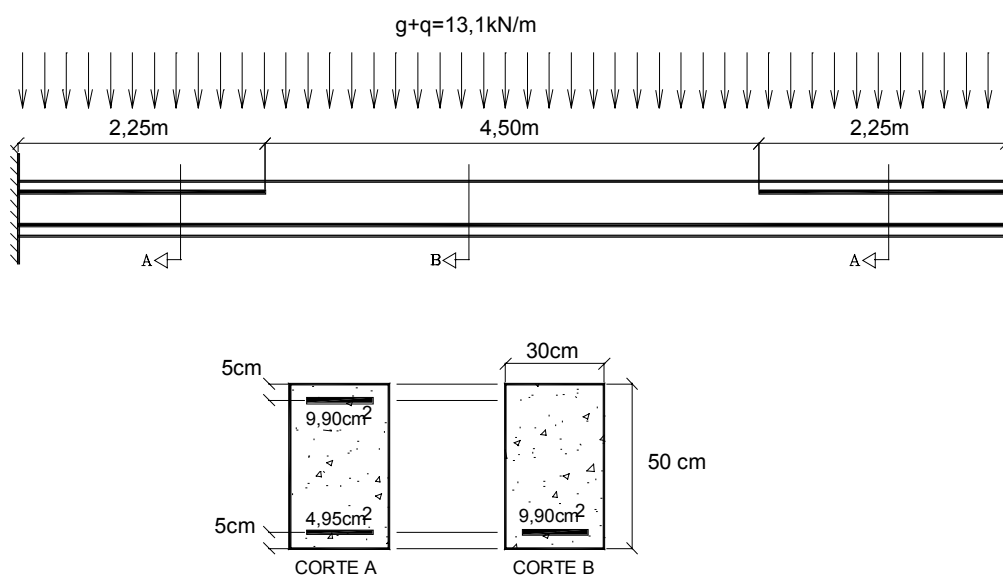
Exemplo 7.2.1- viga bi-engastada de concreto armado.
